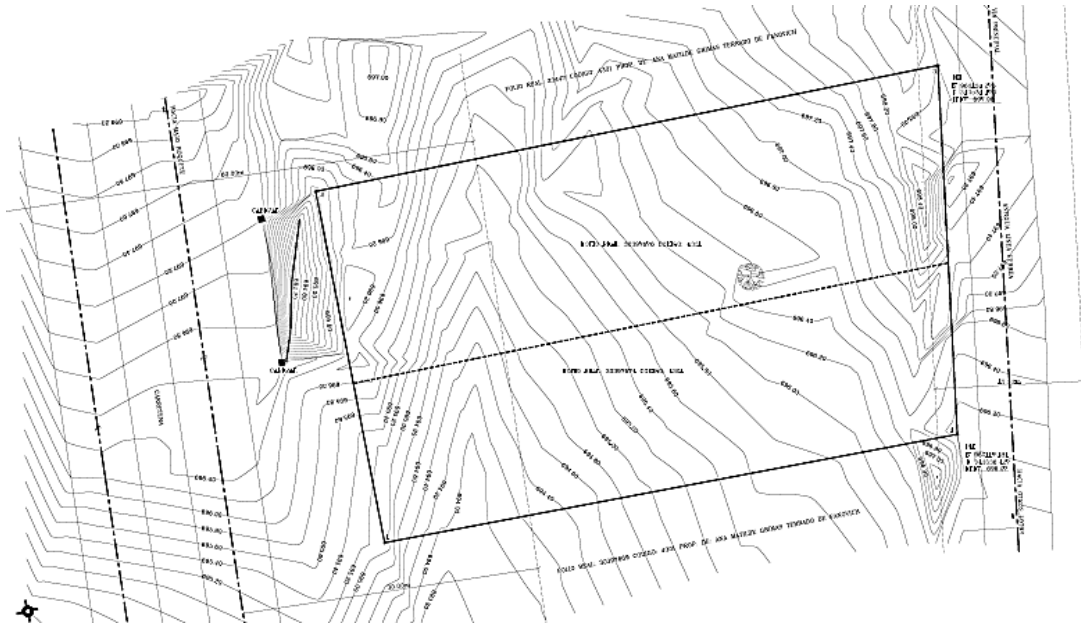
Imagen de la topografía del terreno. Fuente: Planos del proyecto, 2023
